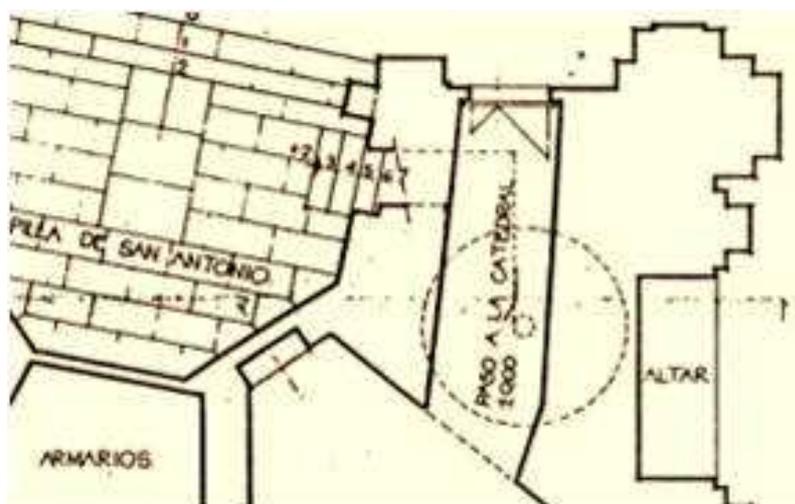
15.9 Detalle de plano anterior, Arranque de la escalera. Estado actual, 1974.
